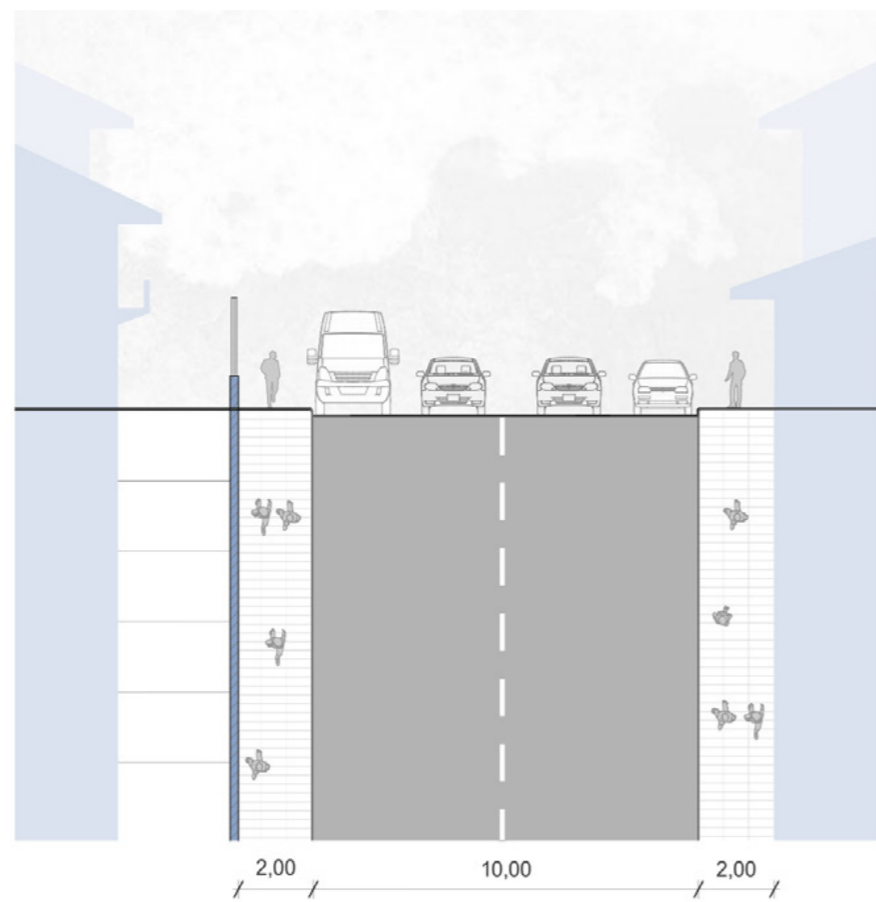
Sección vial estado actual, calles Barrial Blanco. Fuente propia
